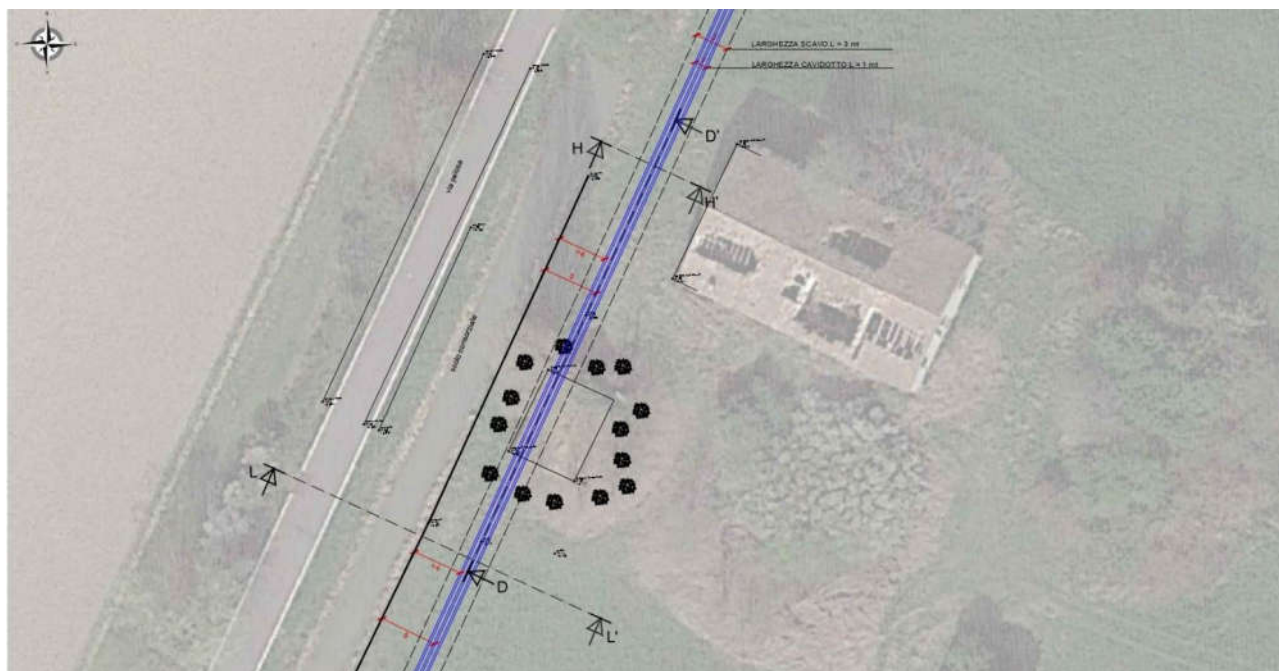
Tratto D-D’ - Rilievo planoaltimetrico post-intervento
